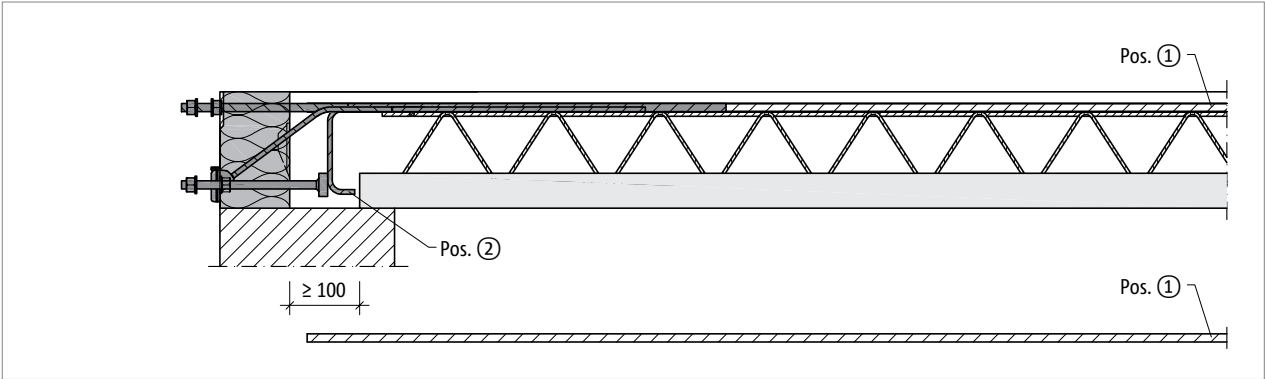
Schöck Isokorb® XT Typ SK-M1: Bauseitige Bewehrung bei Halbfertigteilbauweise, Schnitt
